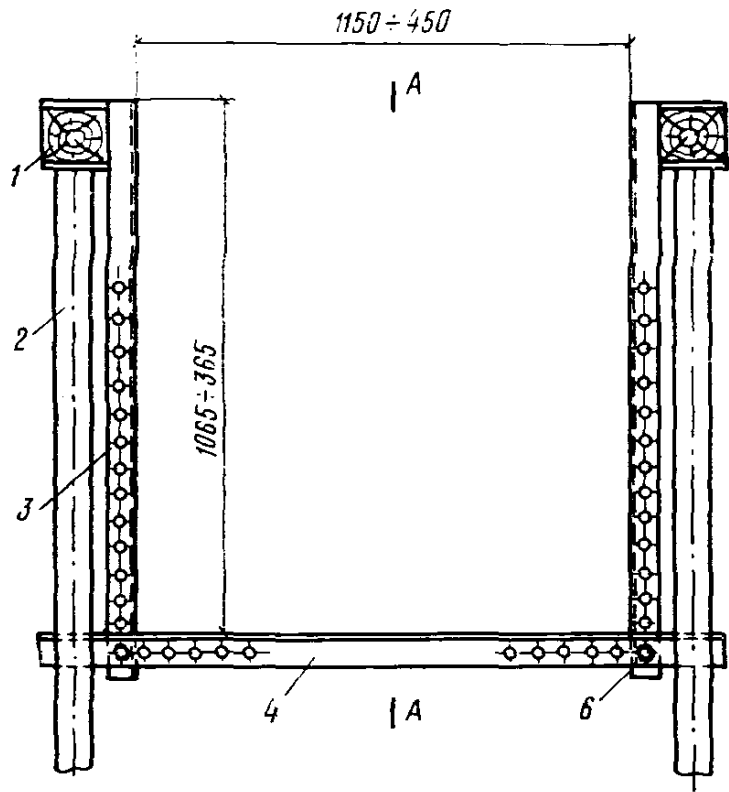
Балочная струбцина для крепления коробов опалубки железобетонных ригелей
